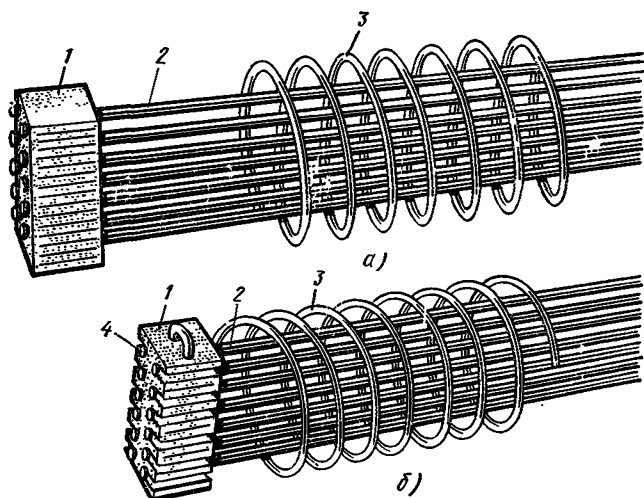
Унифицированные напрягаемые арматурные элементы (УНАЭ):
